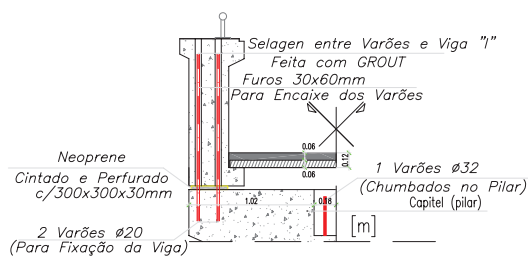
Pormenor de ligação da viga em "I" ao pilar [62]
